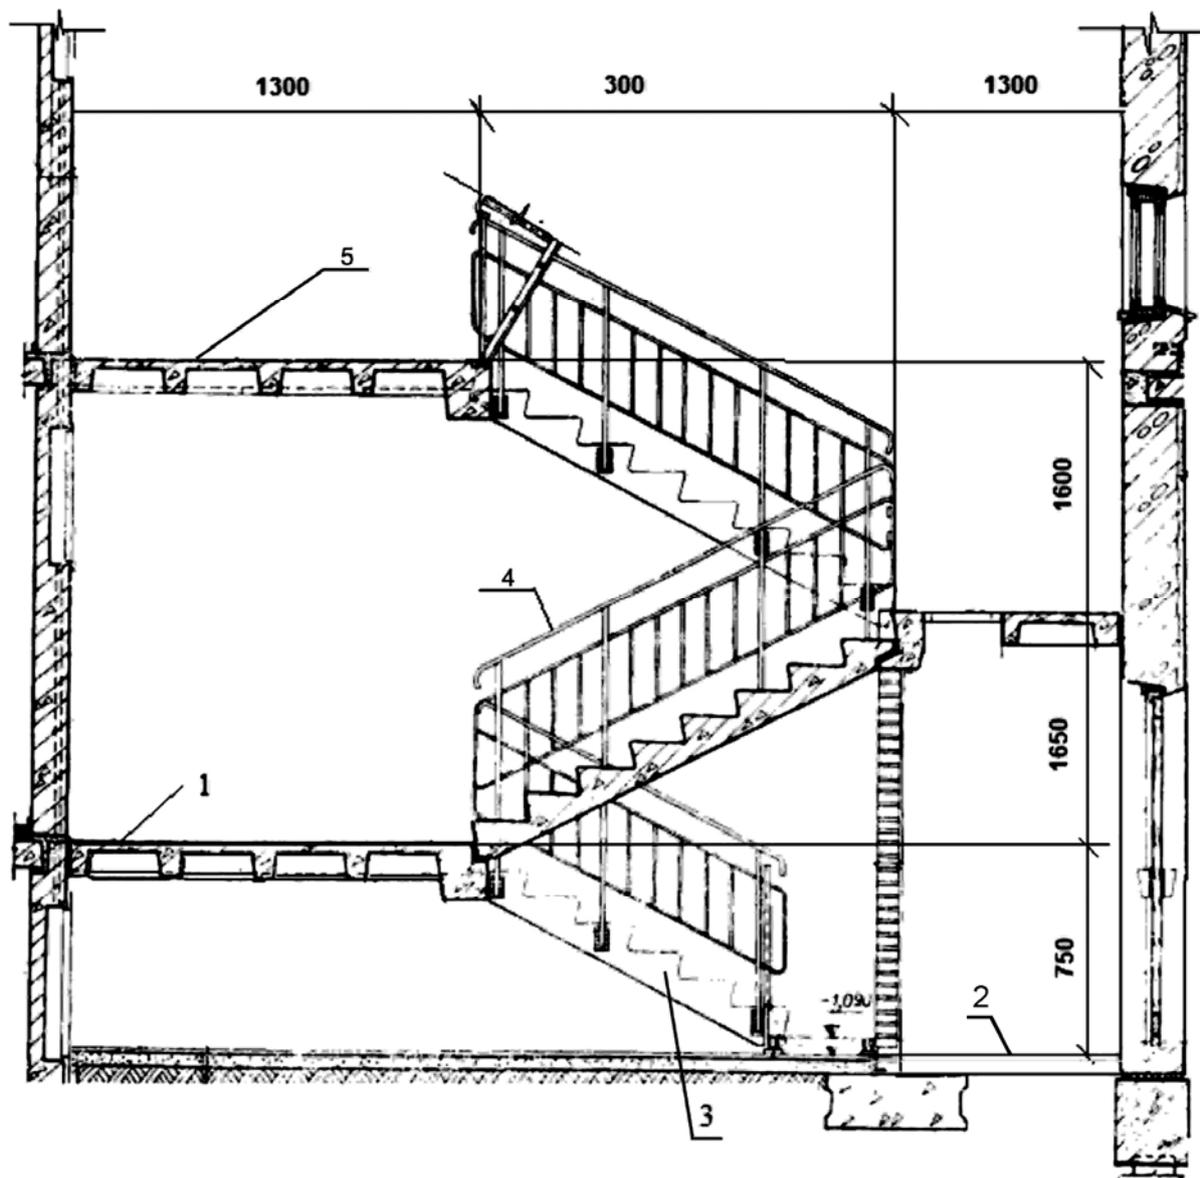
Двумаршевая лестница из сборных железобетонных маршей и площадок. Поперечный разрез: 1 — промежуточная площадка; 2 — входная площадка; 3 — цокальный марш; 4 — перила; 5 — этажные площадки
